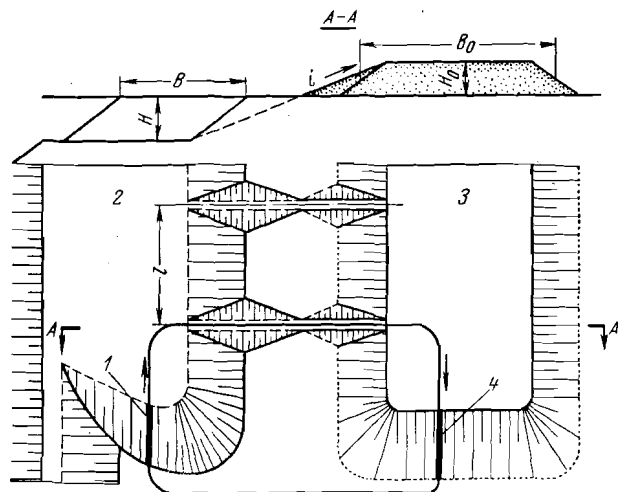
Схема движения колесного скрепера по «вытянутому кольцу»:
